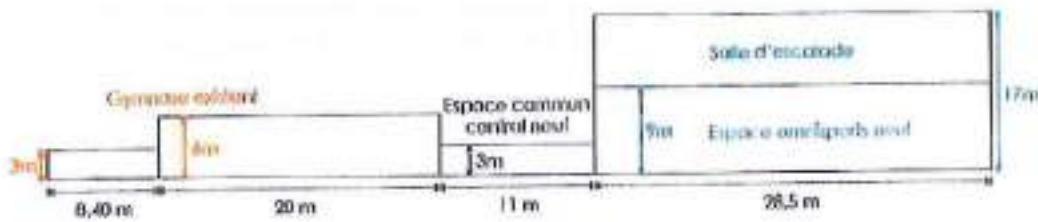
Plan des héberges du complexe sportif – Façade Sud-ouest
